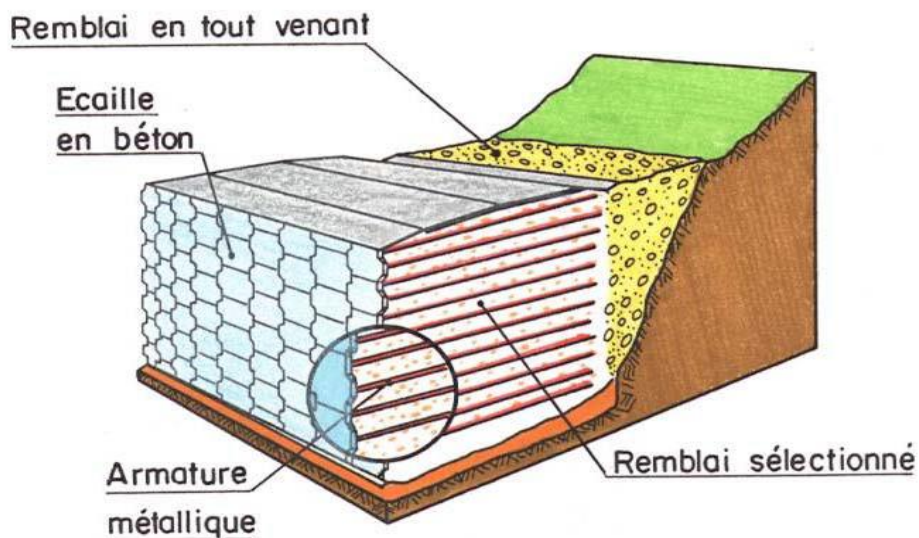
Schéma d'une portion d'un ouvrage en terre armée ; passage d'une route en remblai
